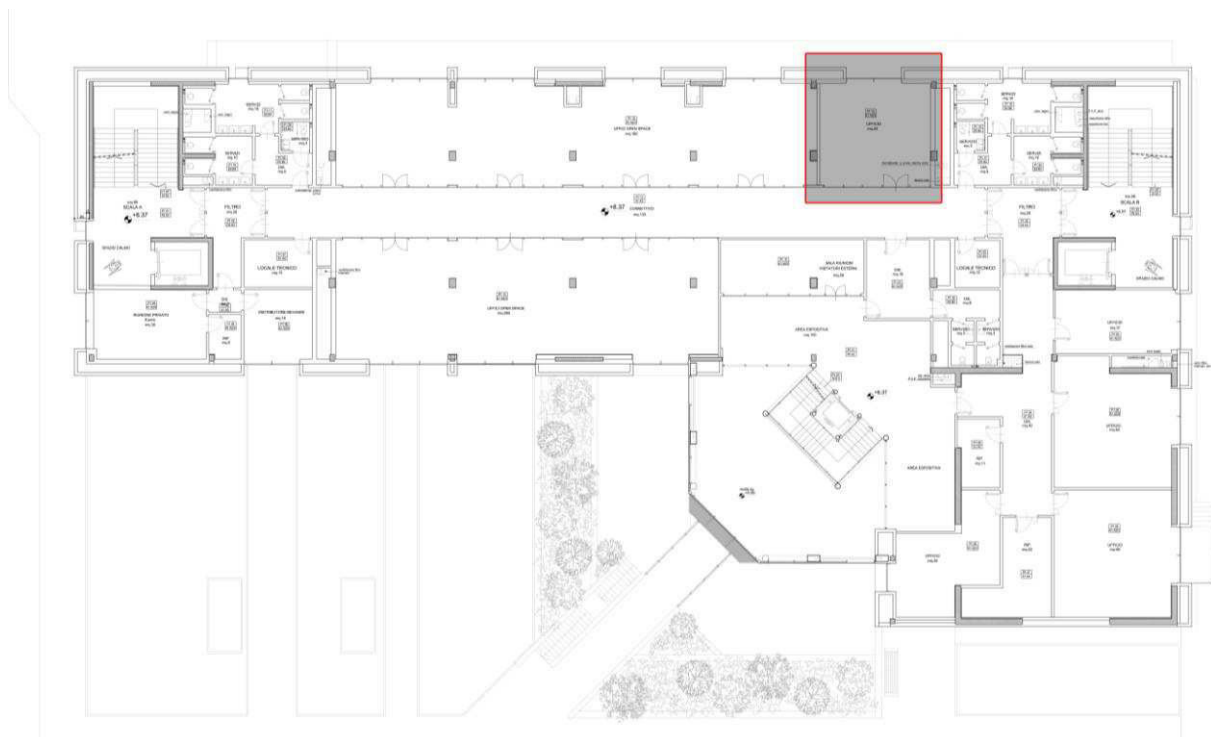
Pianta primo piano con individuazione dell'ambiente analizzato.
